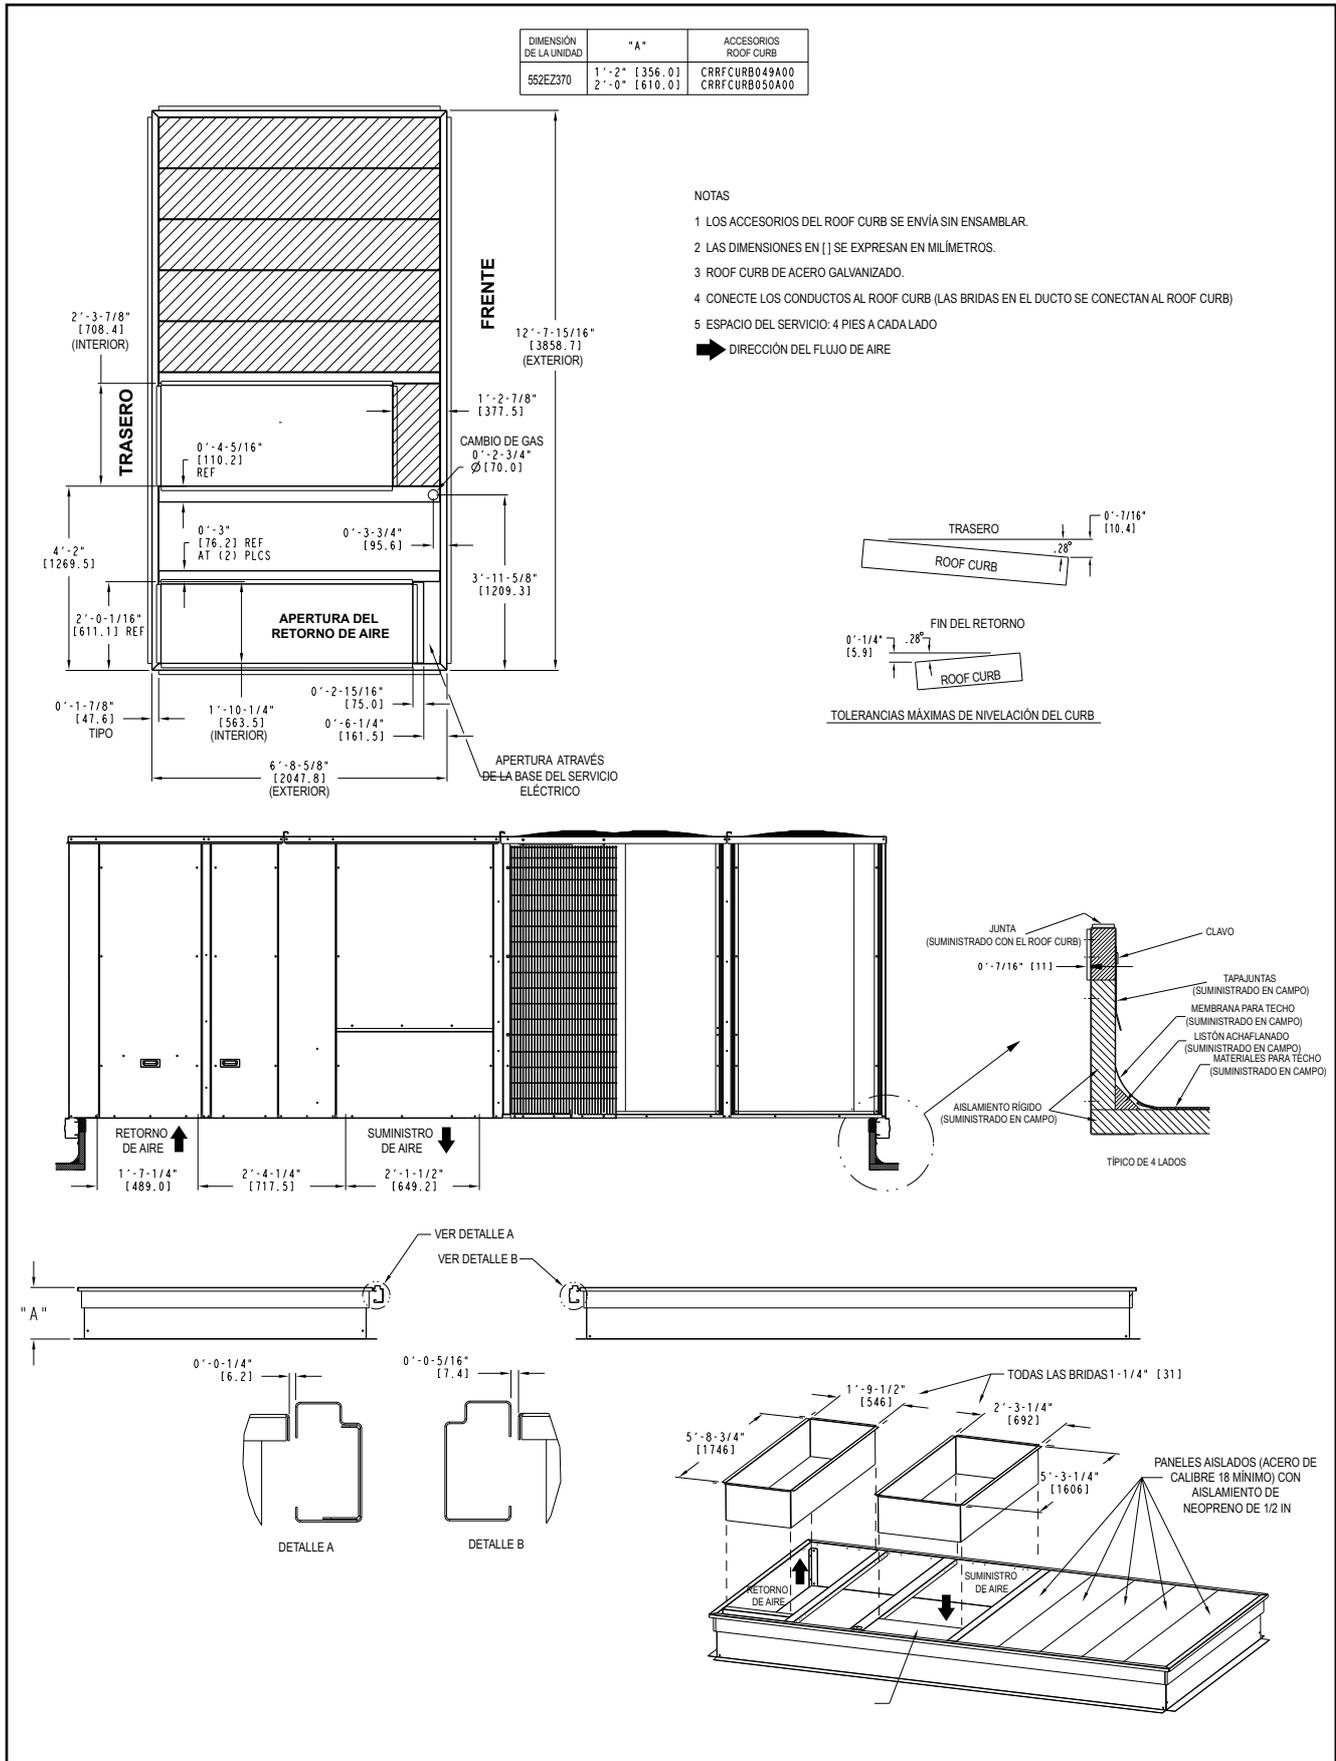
Detalles del Roof Curb - 552E2240 Y 552E2320
